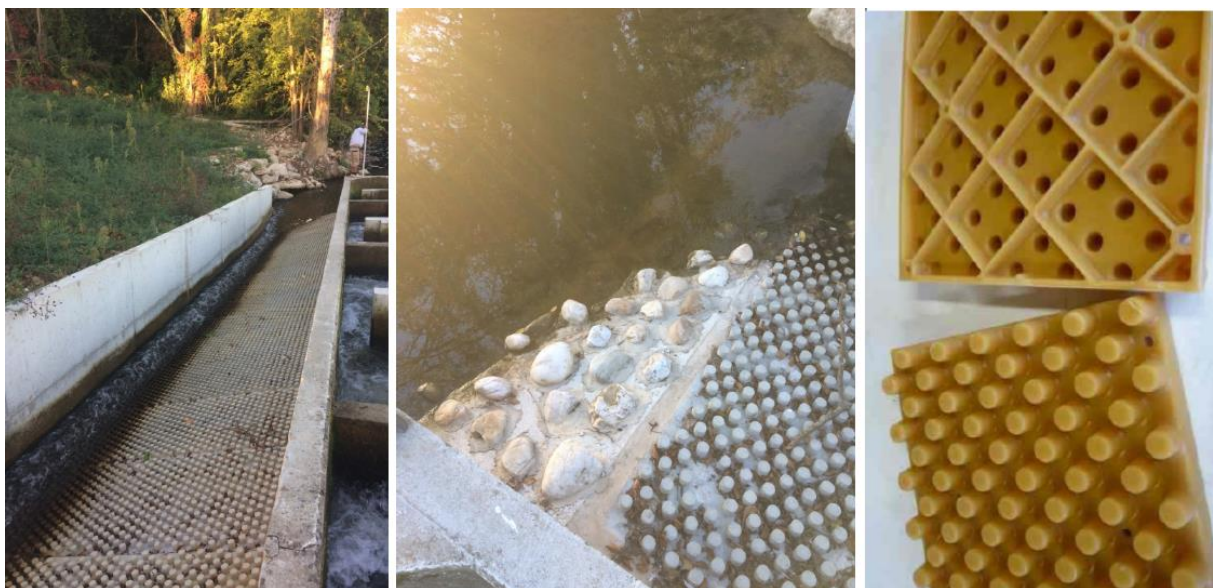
type de rampe à anguille proposé à l'Escalier – substrat ABS
